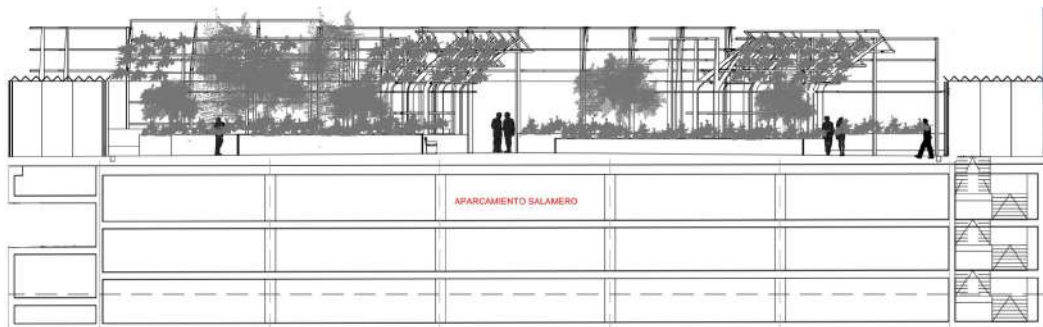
Sección con parking, Plaza Salamero. Fuente:
